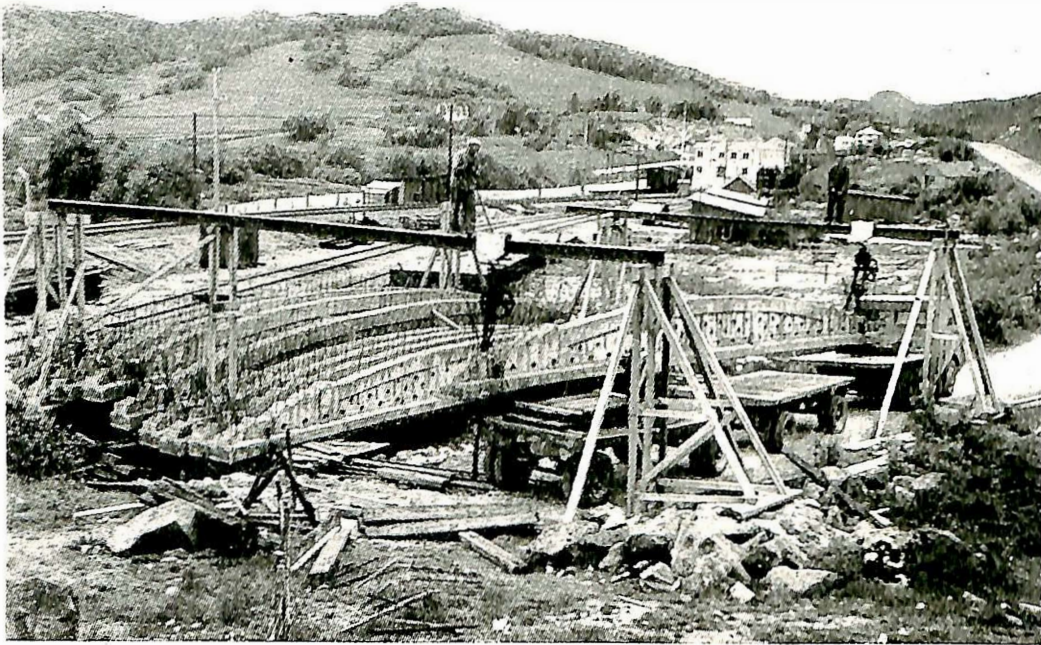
En del av de lagrede stålbetongdragere på Eide jernbanestasjon ved Egersund. Lossing av betongdragerne.
